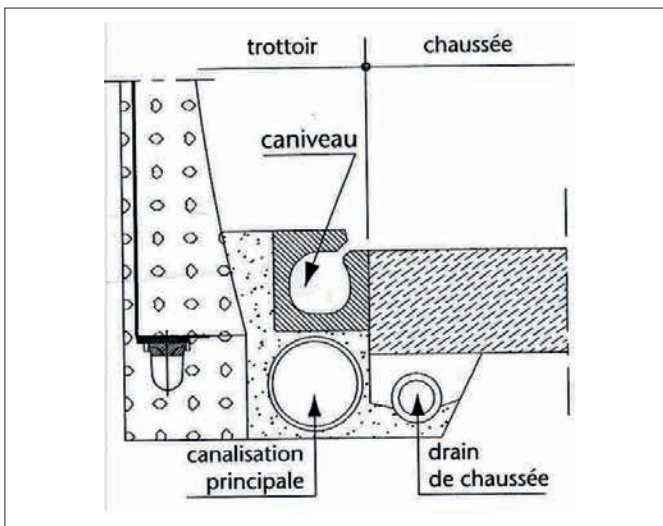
caniveau d'extrados, drain de chaussée, collecteur et caniveau à fente
